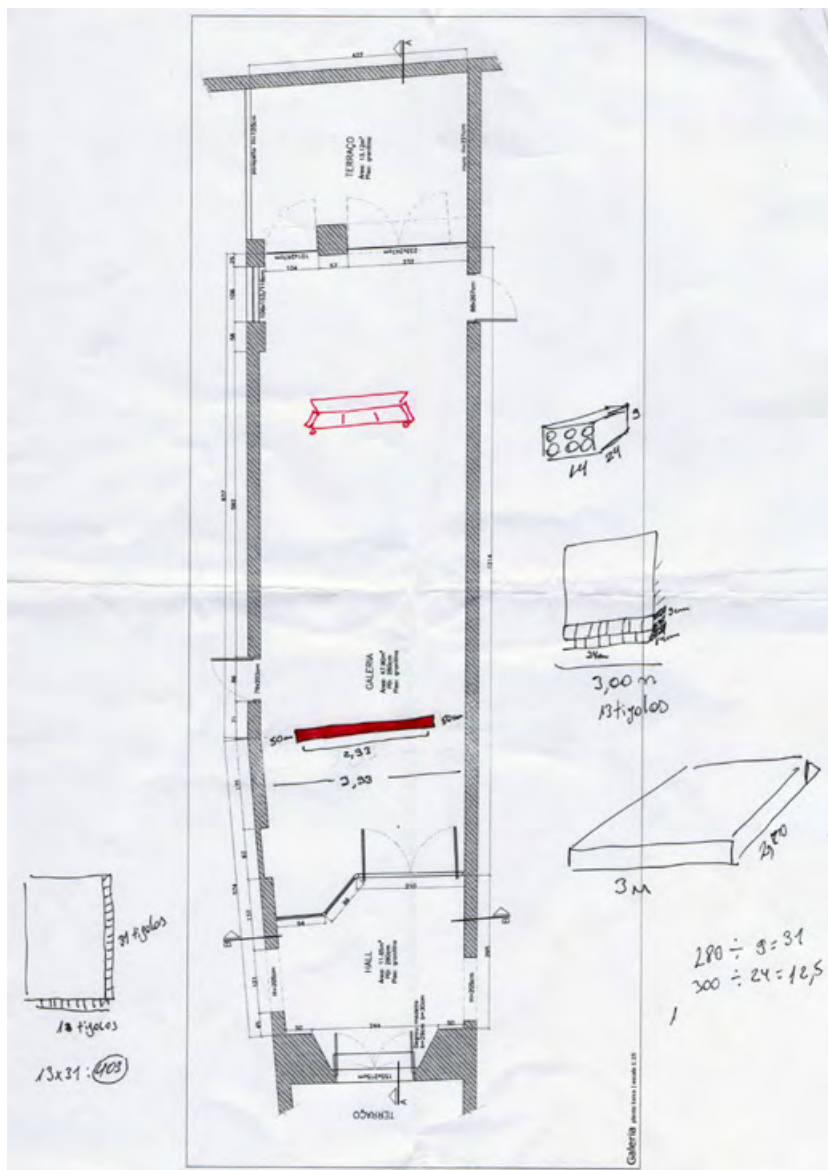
Nathalia García. Planta baixa com a posição dos tijolos e do sofá.
